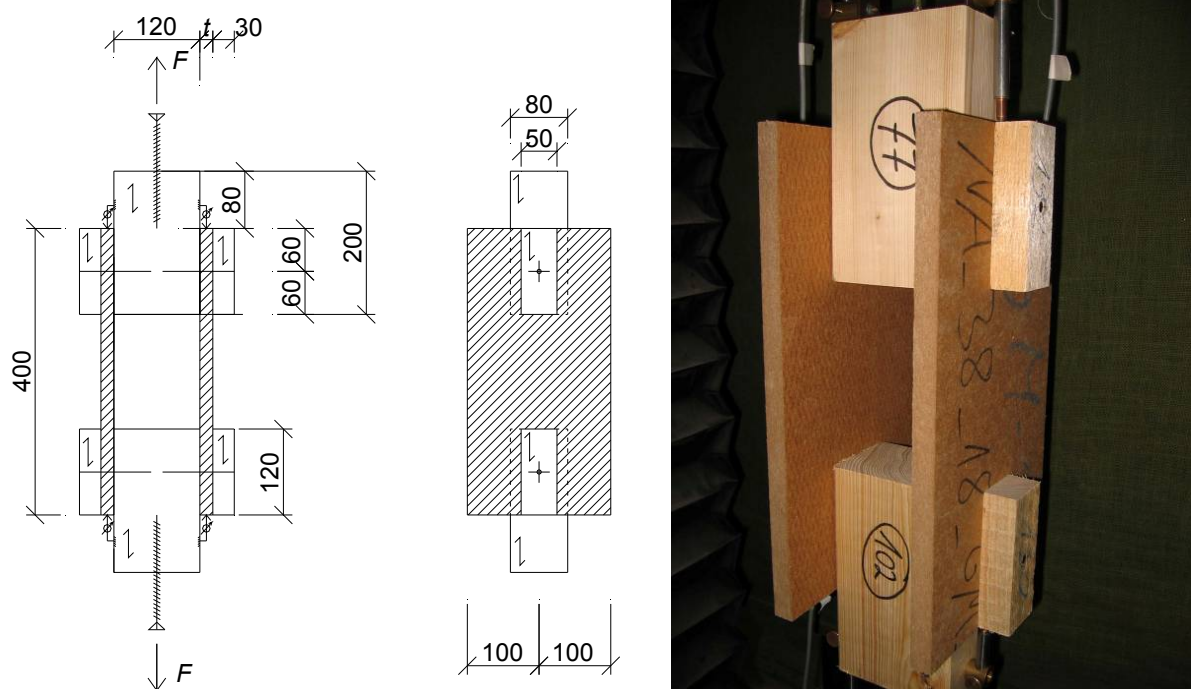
Zugscherkörper einer Holz-HFDP-Verbindung mit Nägeln (Maße in mm)
